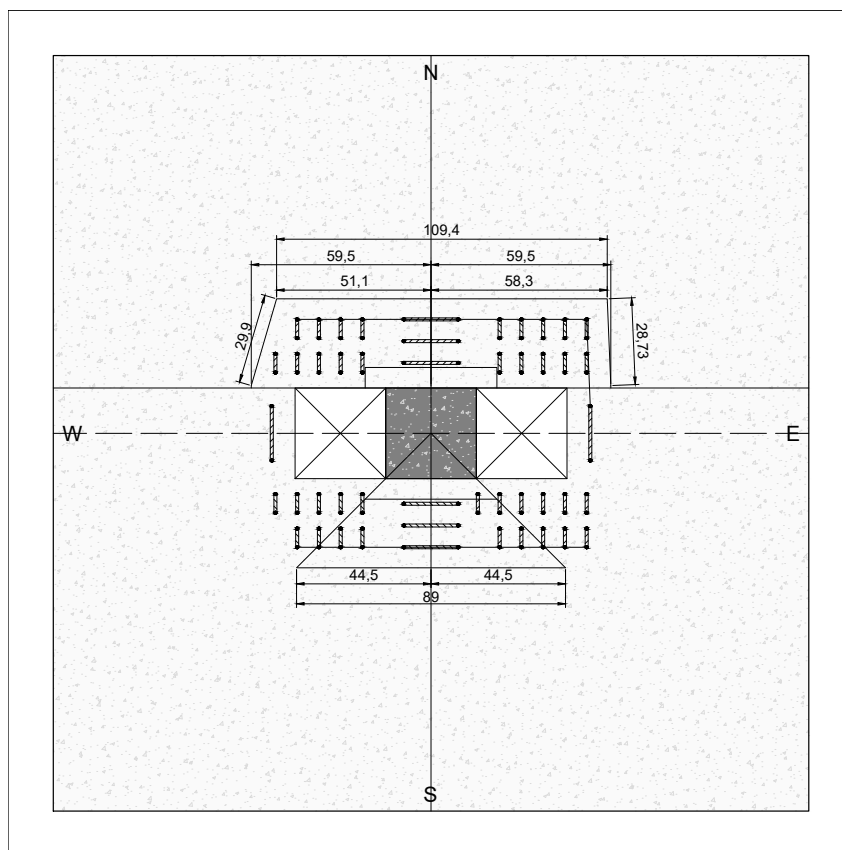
Perímetros externos segundo ACI 318-19 da laje LFE3
